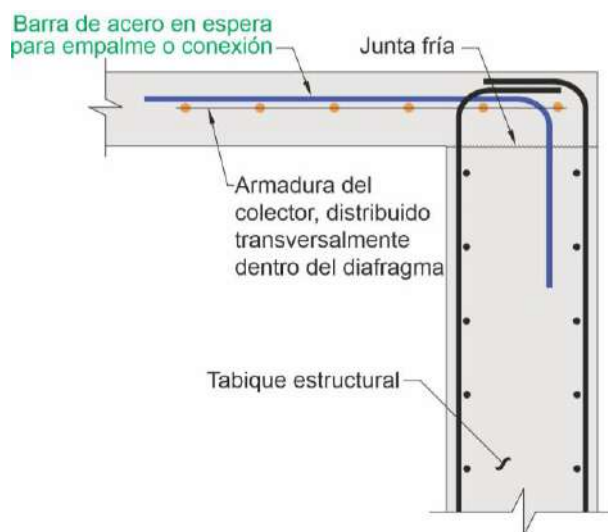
Detalles de barras aportadas para transferir corte a un tabique estructural a través de la armadura de corte por fricción.
